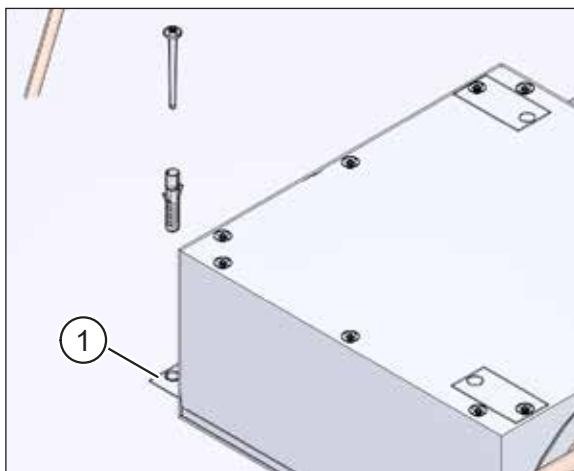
Fixer le caisson de plafond en tôle d'acier sur les prédalles
